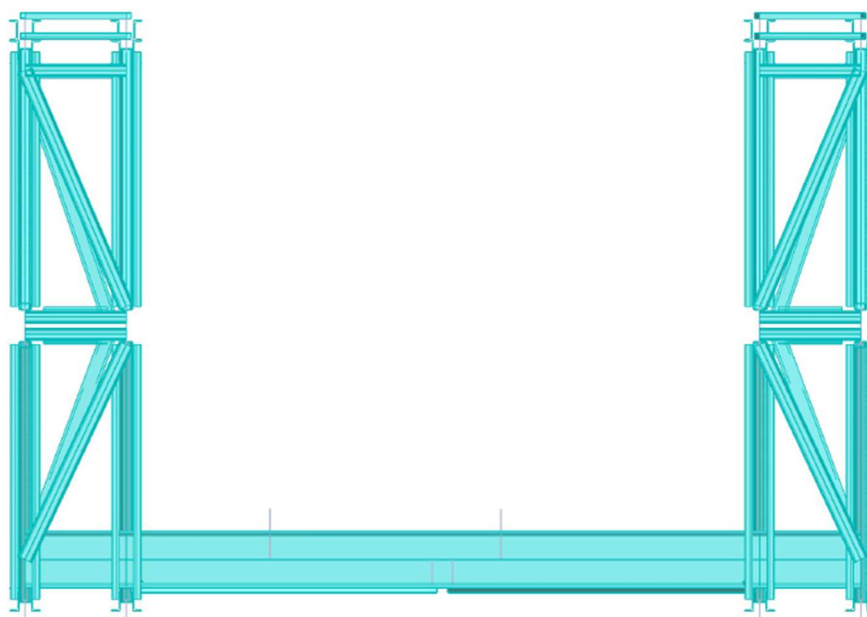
Secção transversal, de ponte com dois níveis de painéis, dois planos e uma faixa de rodagem
